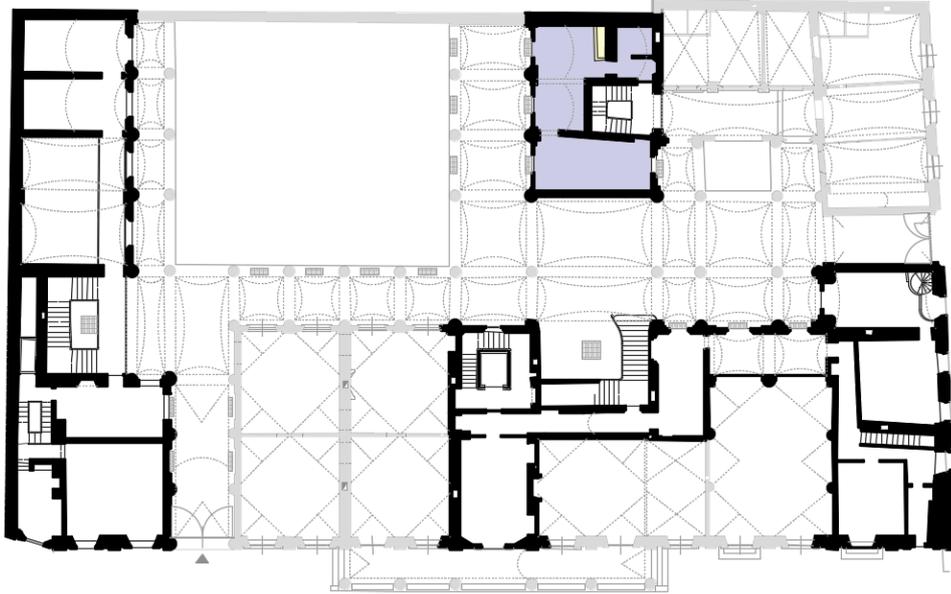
Pianta piano ammezzato. Area di distribuzione della UTA 1.
